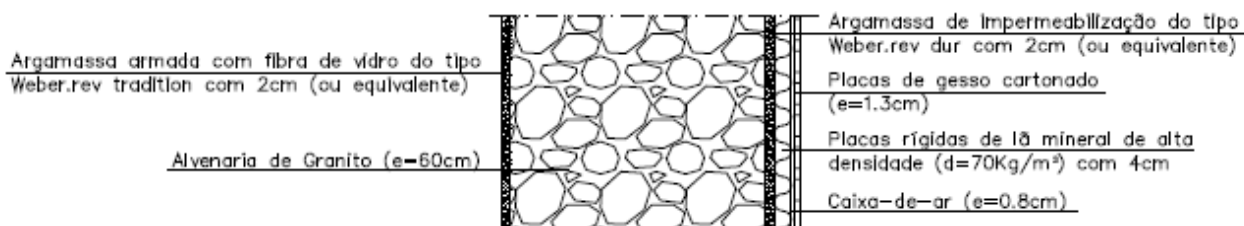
Pormenor construtivo da parede exterior das fachadas frontal e do tardo (Projeto de CT)
